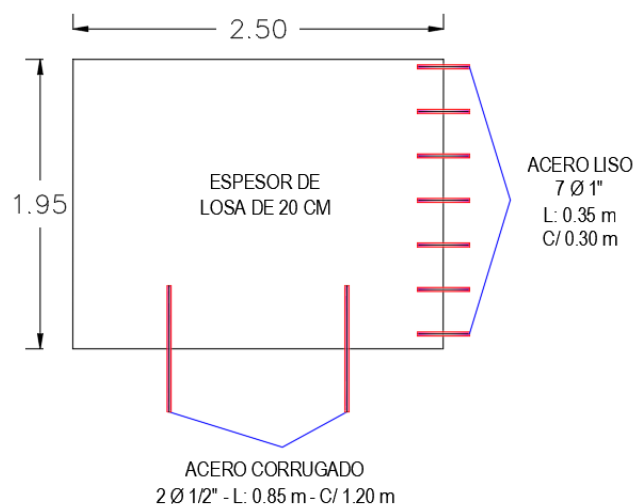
Detalle placa de borde 2.00x2.50 m
